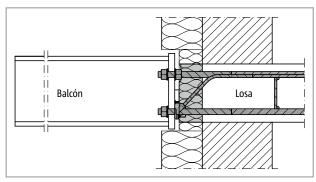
Schöck Isokorb® T tipo SK: Conexión a la losa de hormigón armado; elemento aislante dentro del aislamiento externo
